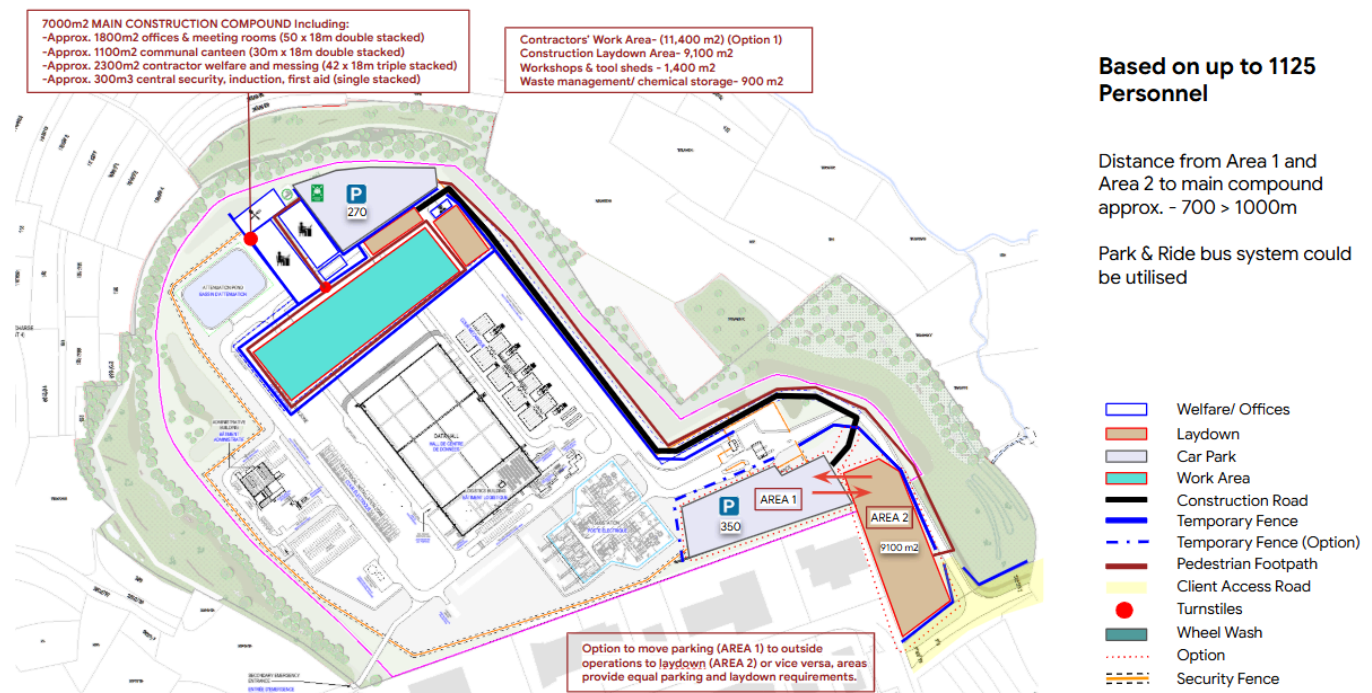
Prévision de l'enceinte de construction. Source: London Bridge, modifié par l'auteur.
